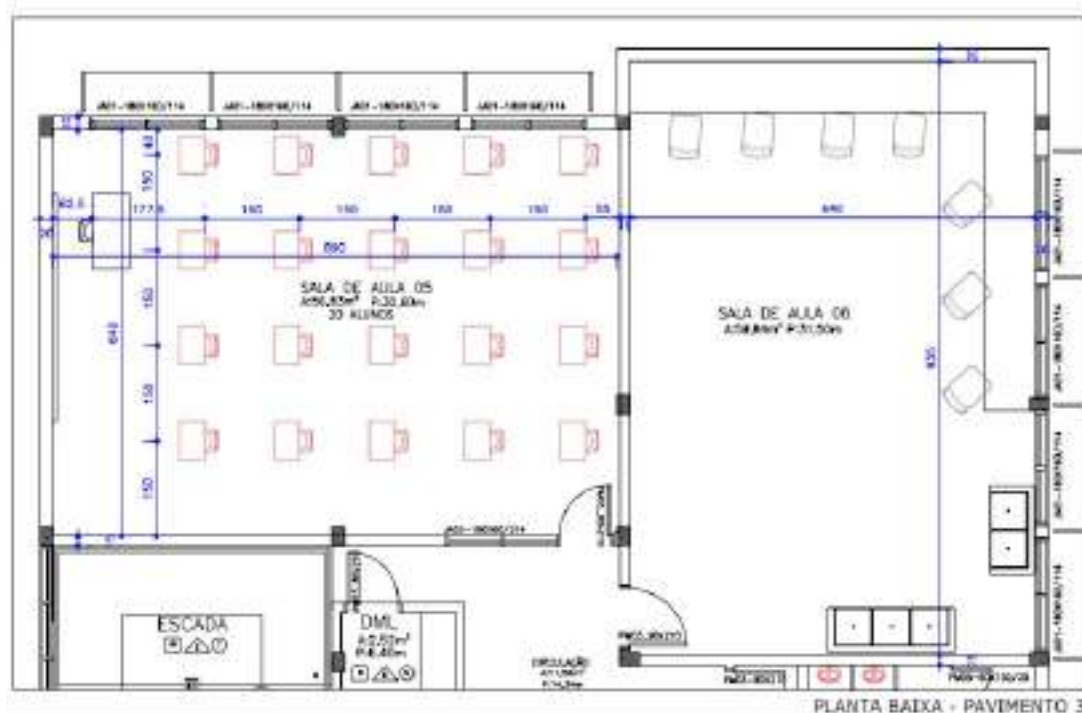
c: Planta baixa terceiro pavimento com distribuição das classes e cadeiras mantendo o distanciamento de 1,5m.
